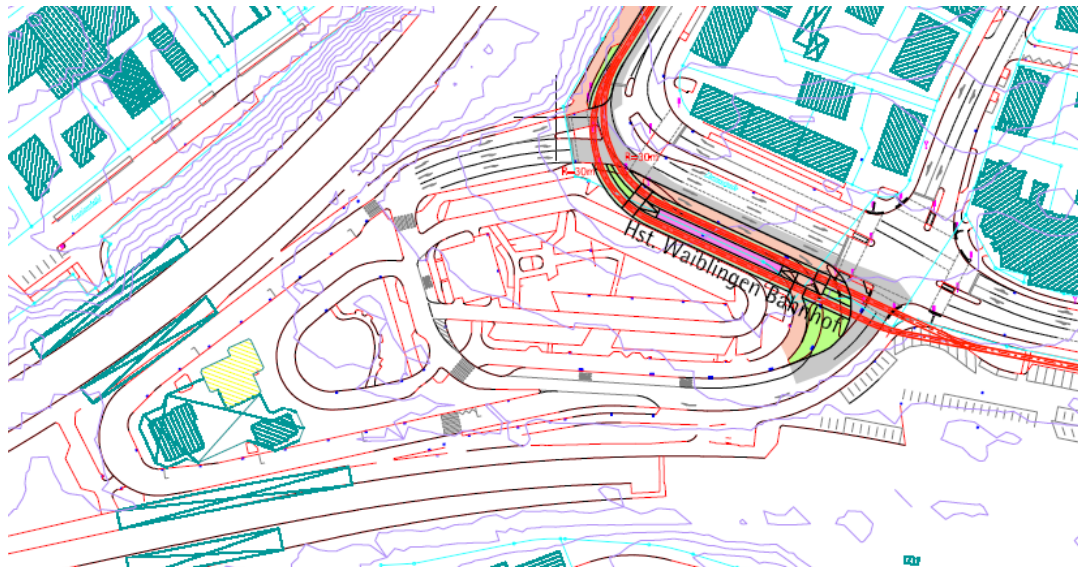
Lageplan Endstelle Waiblingen Bf
